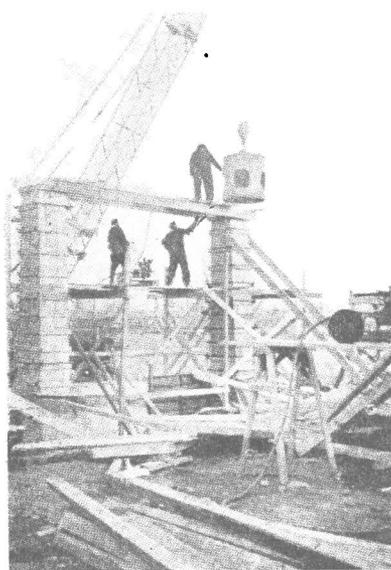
Las columnas se construyen con hormigón transportado por mezcladora de camión. Todas las columnas de un edificio se pueden construir completamente por 40 hombres. El trabajo consiste de armar las formas, vaciar el hormigón, vibrarlo y quitar las formas.
